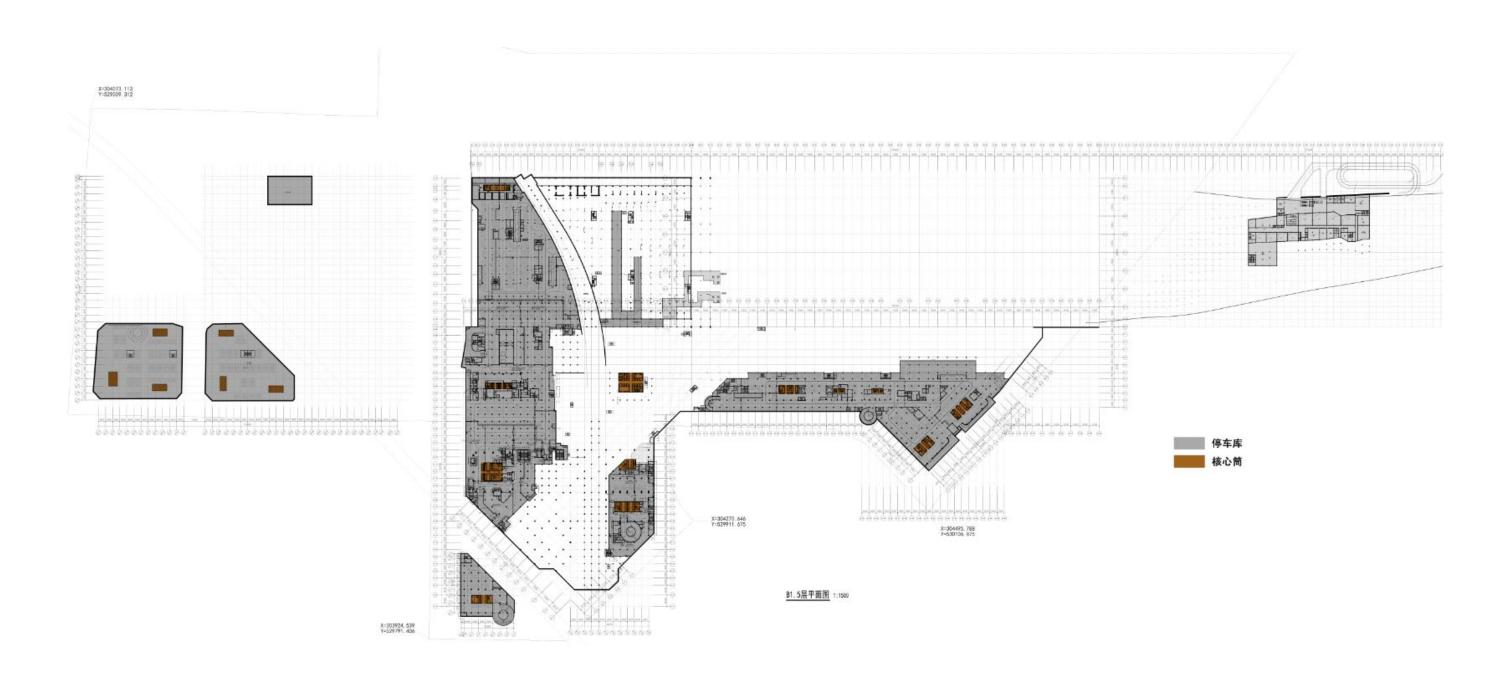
项目地下二层夹层(B1.5 层)平面图
